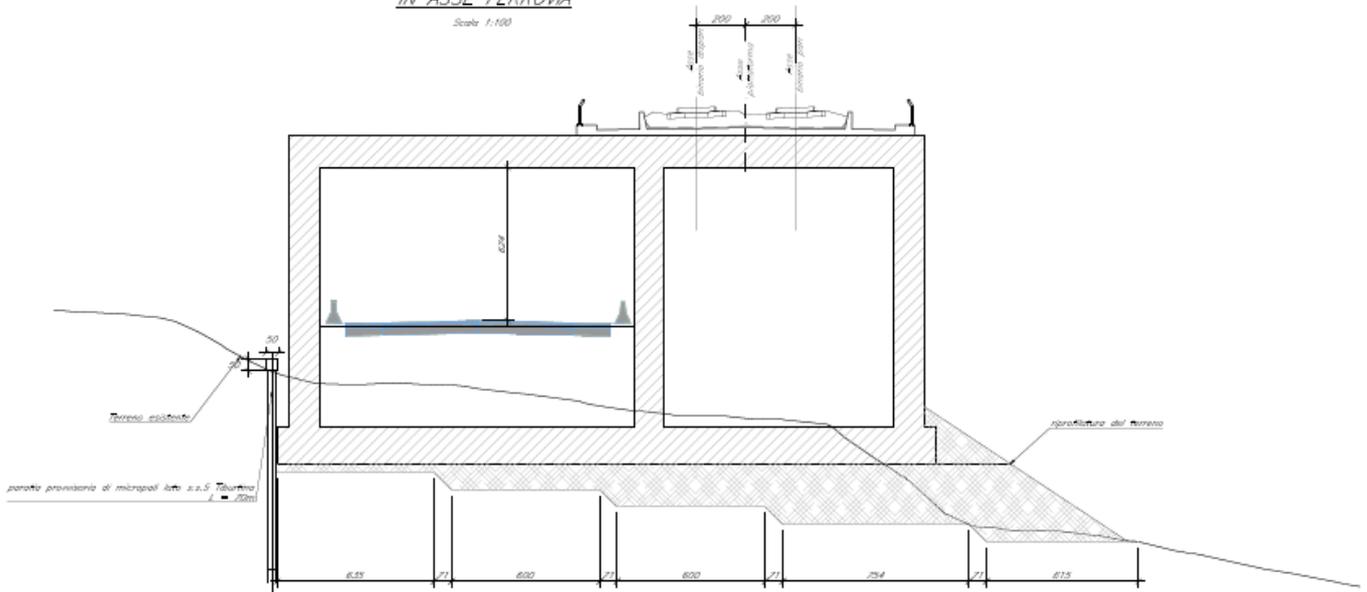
SL21 – Sezione trasversale in asse ferrovia, lato Scafa
